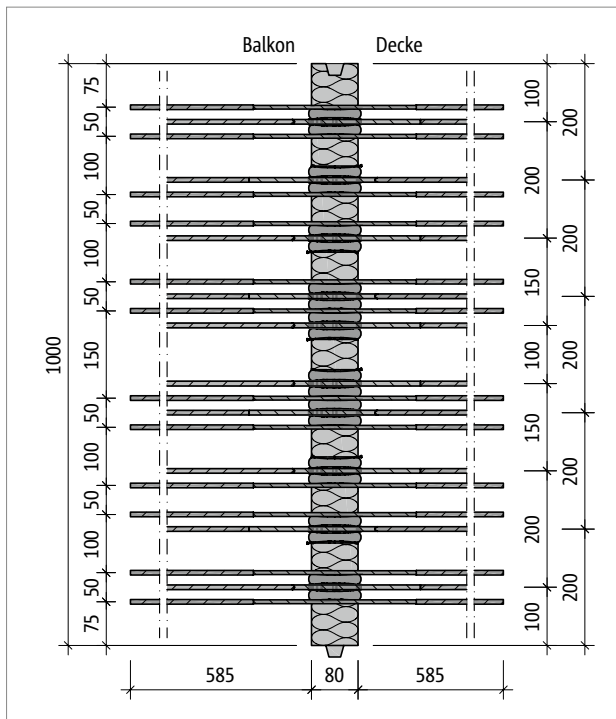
Schöck Isokorb® T Typ KL-M4-VV1: Produktgrundriss
